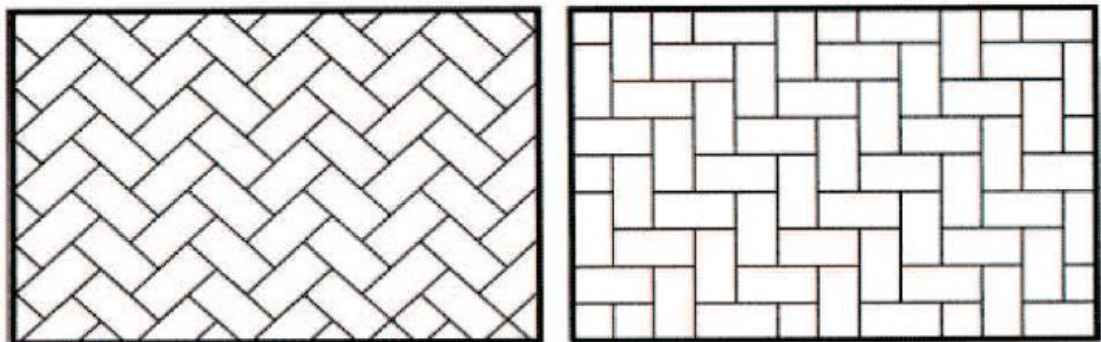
Tipos de Bloques – Fuente: Interlocking Concrete Pavement Institute
